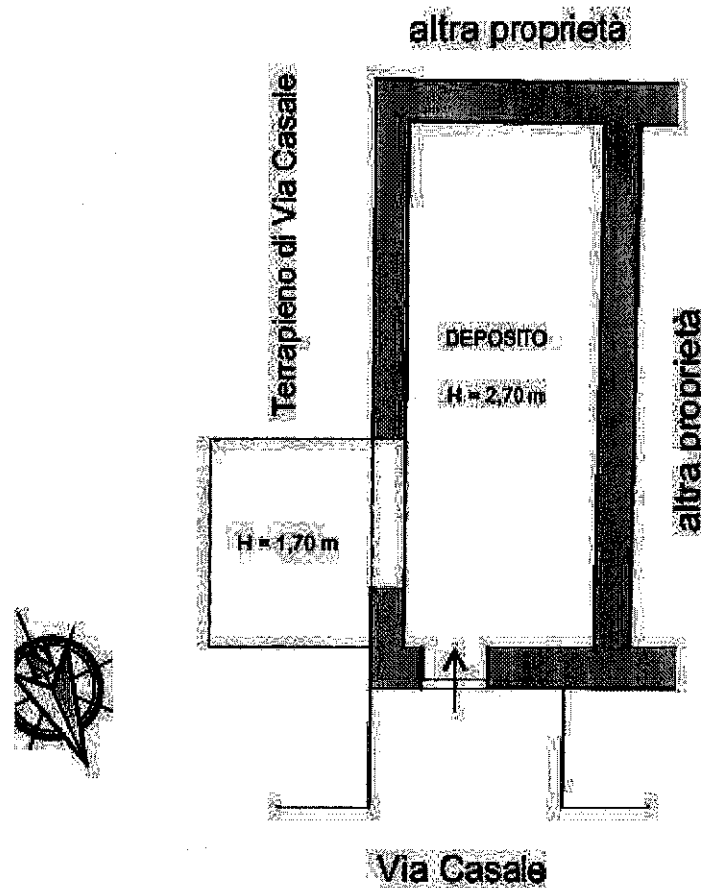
LOTTO 3 – planimetria deposito a piano terra
